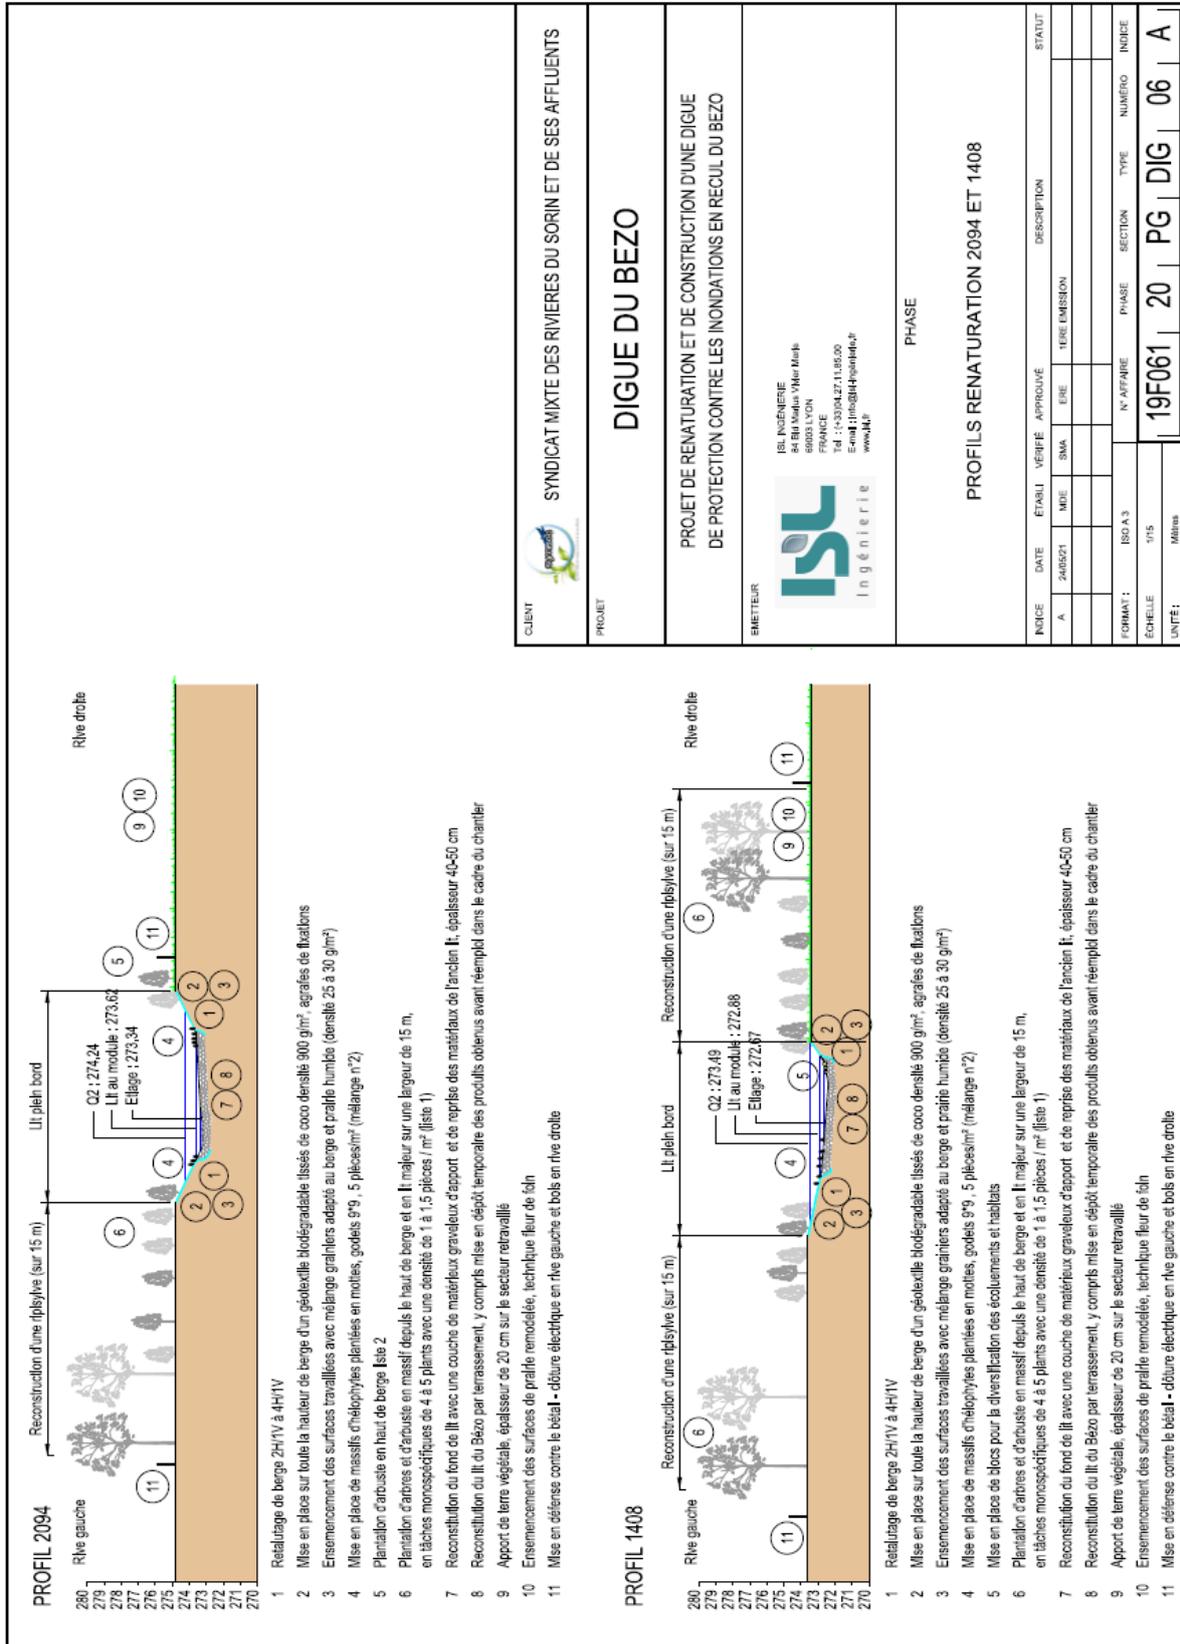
Profil en travers des section 2094 et 1408 du Bézo
